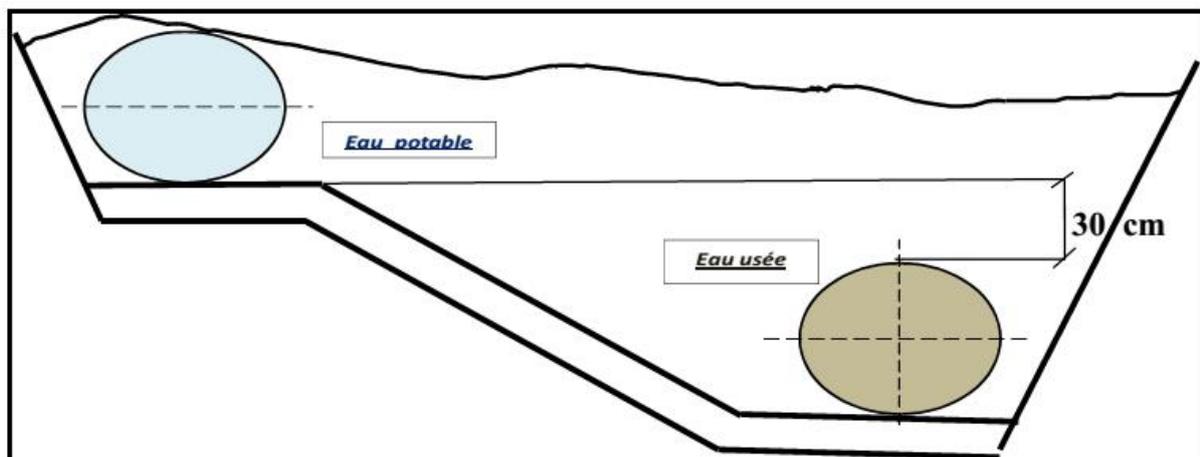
Pose à proximité d'une conduite d'assainissement
